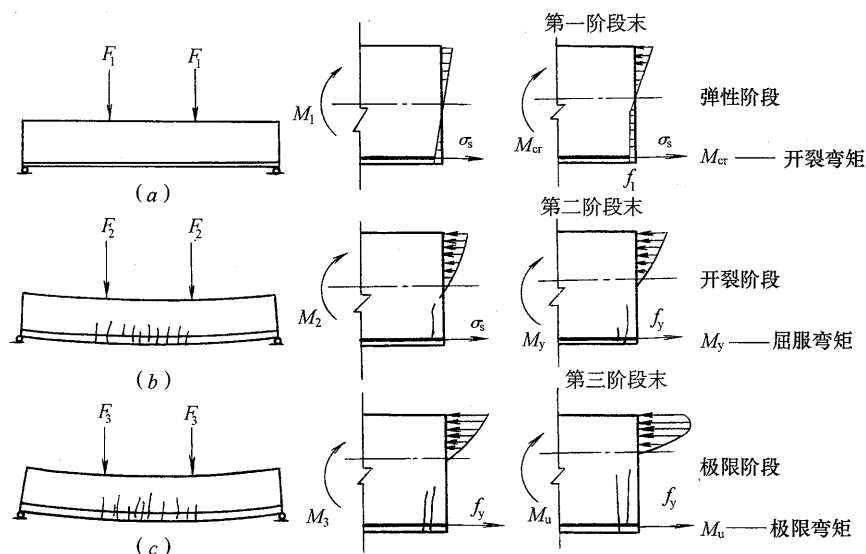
钢筋混凝土梁受弯时各阶段正截面应力分布
